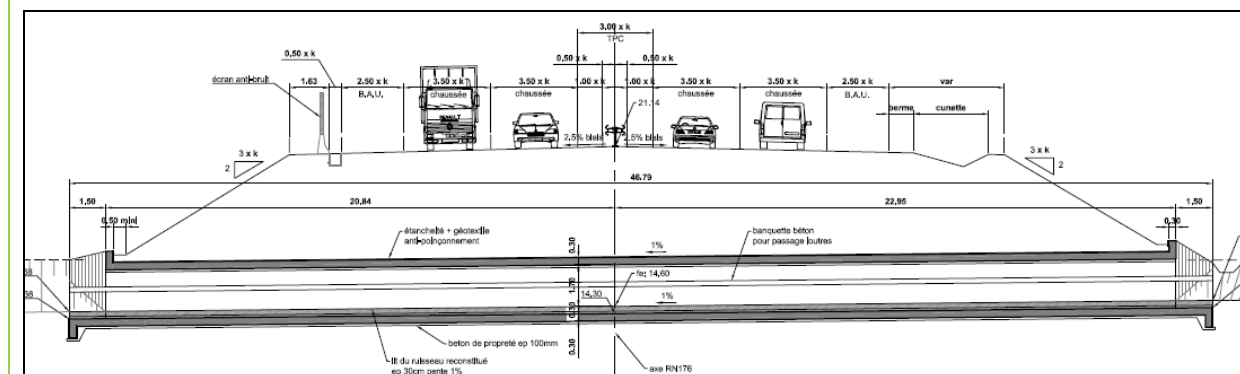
Coupe longitudinale de l'OH (source ARCADIS)
